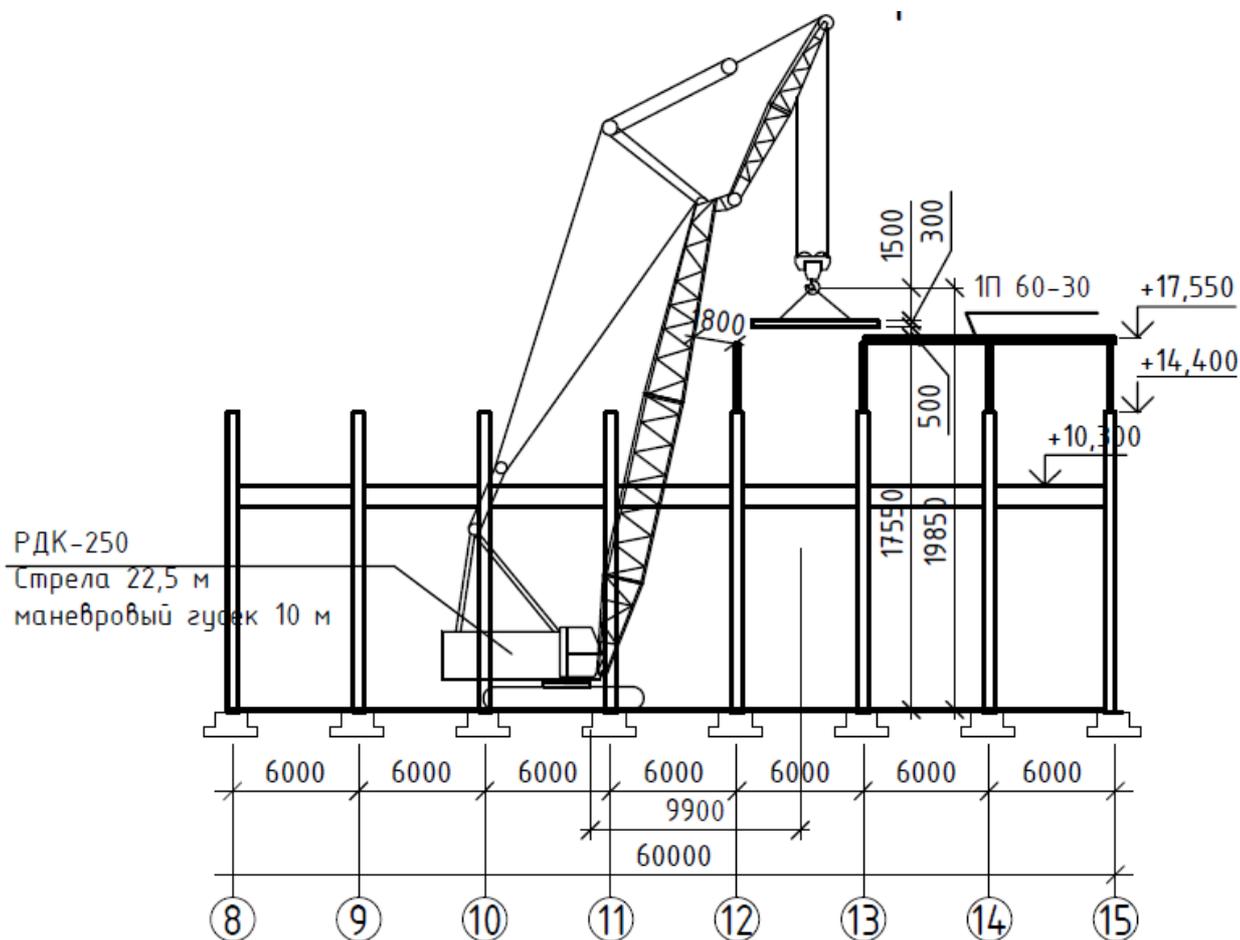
Расчетная схема монтажа плит покрытия (выполнил Наумов Р.С. гр. ТМНК-18).
